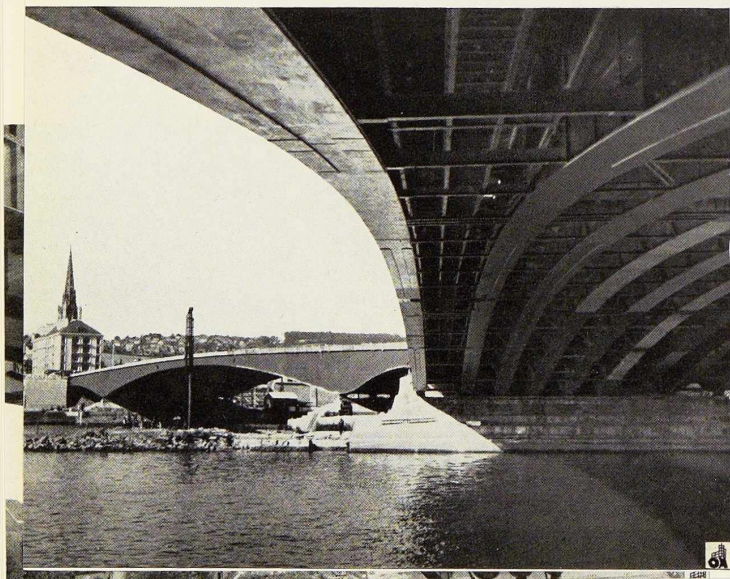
Entroisement des maîtresses-poutres du pont Corneille et parement Ouest frappé par le soleil couchant.
